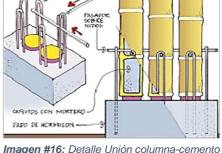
Detalle Unión columna-cemento Fuente: Investigación
